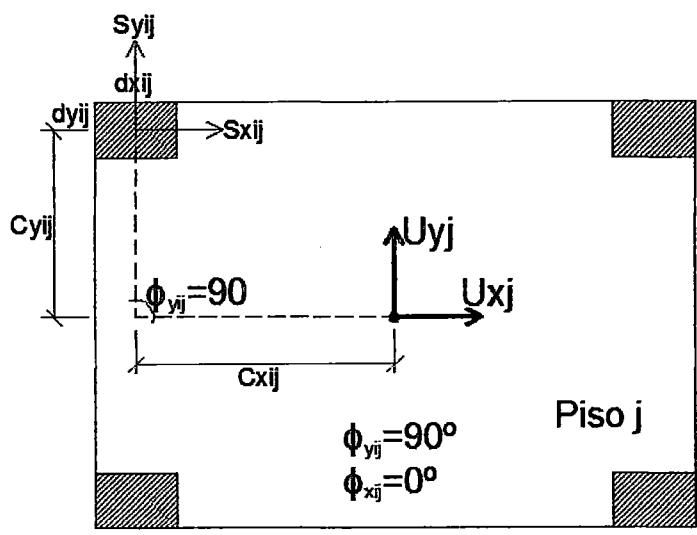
Orientación de la columna en el sistema de coordenadas.
